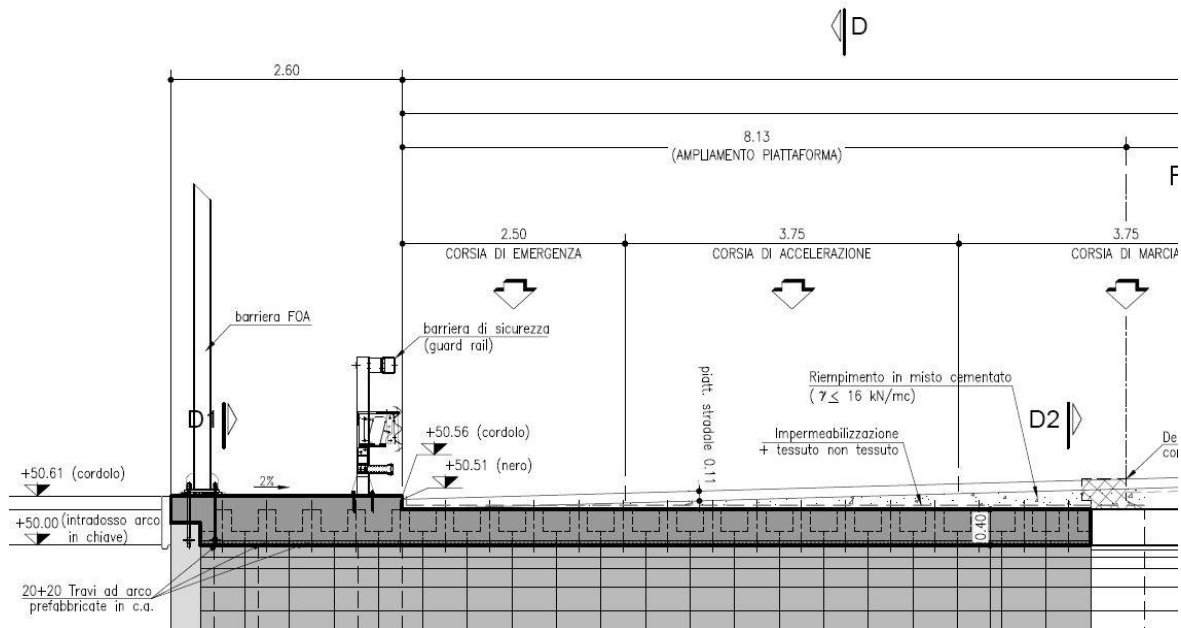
Sezione tipo struttura di sostegno in allargamento.
